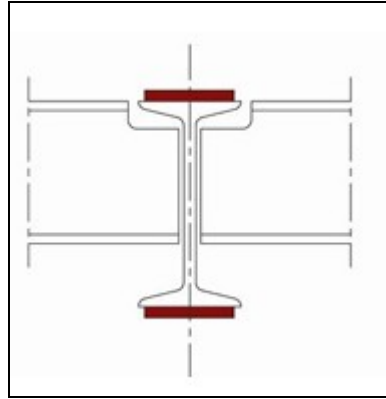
a Ajout de plats soudés sur les semelles
